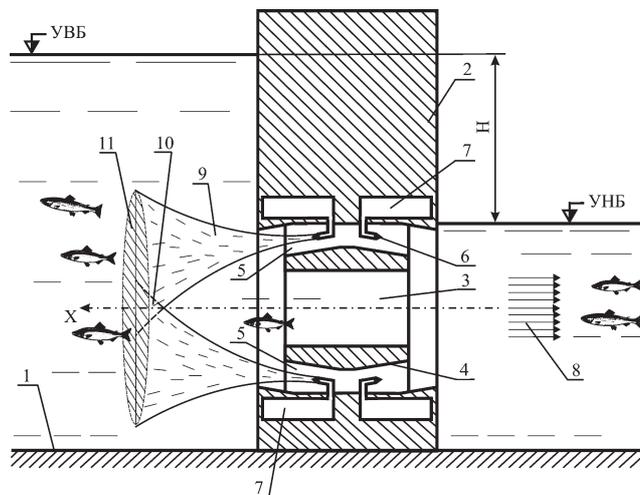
Схема «гидравлического затвора» рыбопропускного сооружения: 1 — рыбопропускной тракт; 2 — поперечная разделительная стенка; 3 — вливное отверстие; 4 — потокоформирующий фартук; 5 — транзитные галереи; 6 — струеобразующие насадки (сопла); 7 — напорные коллекторы; 8 — привлекающий поток; 9 — водяные струи; 10 — противоток; 11 — зона «частично равных давлений»
